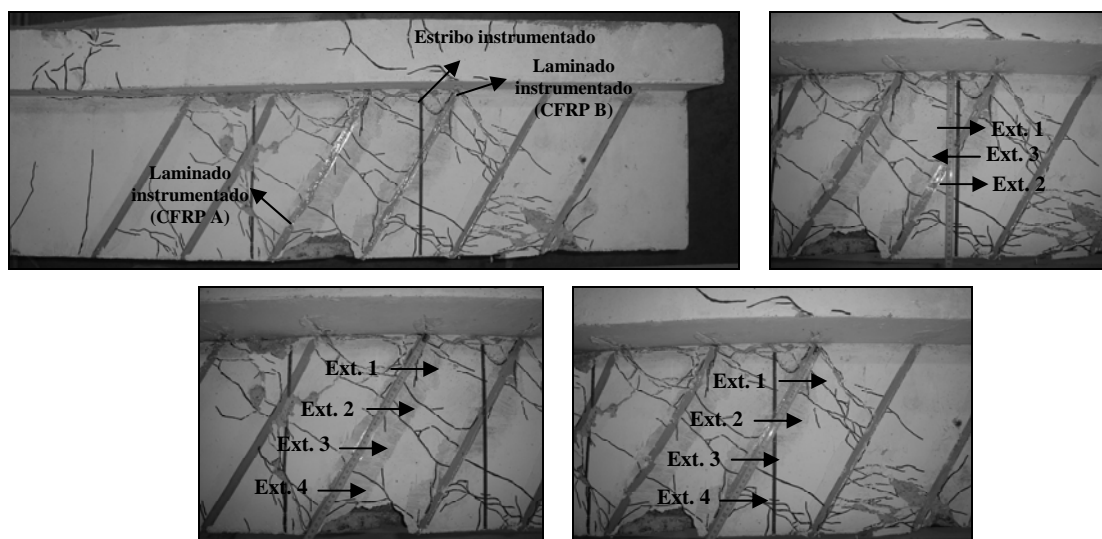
Localização dos extensómetros no laminado e estribo instrumentados da viga 2S-6LI60-C.
